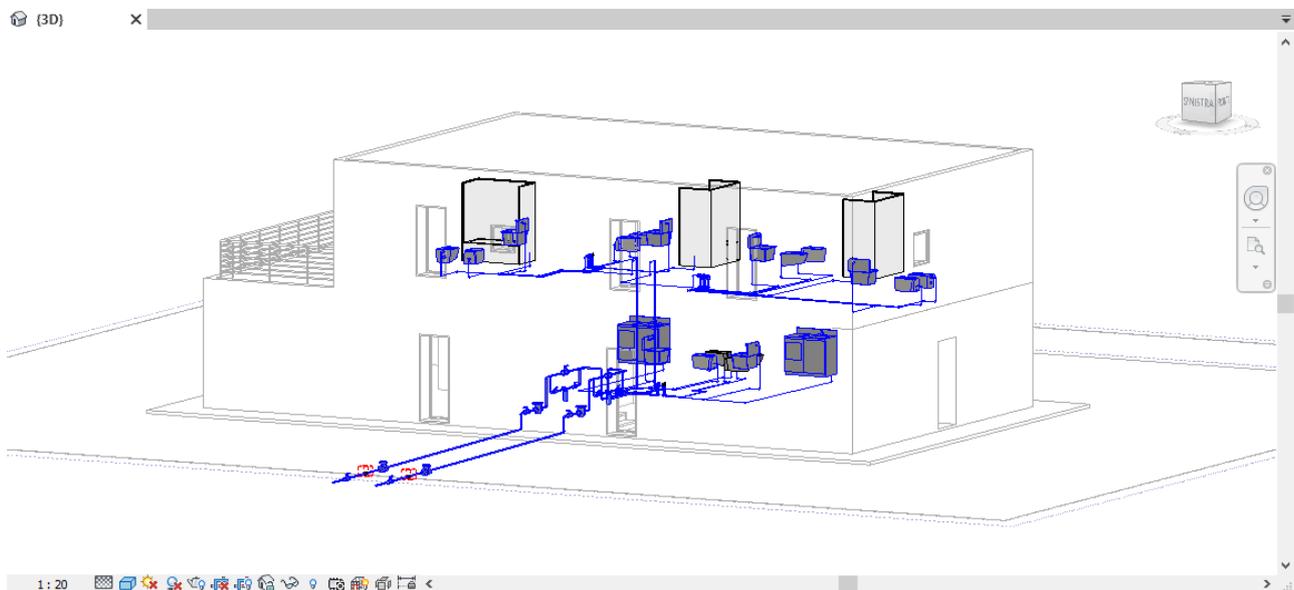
Vista tridimensionale (3D): Modello impiantistico
